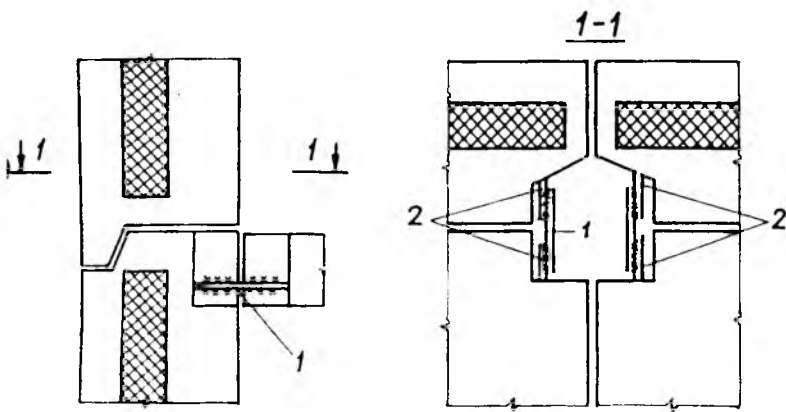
Усовершенствованный узел сопряжения панелей стен и плит перекрытий
